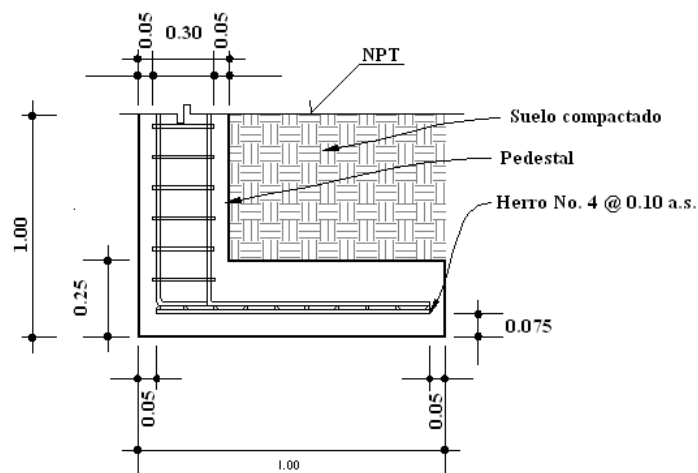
DETALLE DE ZAPATA DE COLINDANCIA
